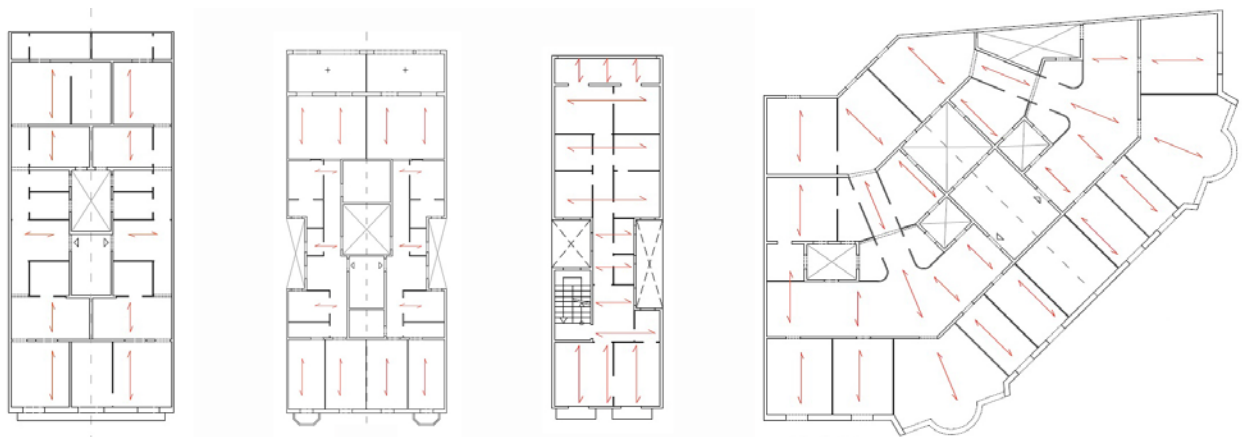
Ejemplos más abundantes [14] de esquemas estructurales en planta de los edificios originales objeto de remonta, en banda (escalera central y lateral) y chaflán.
